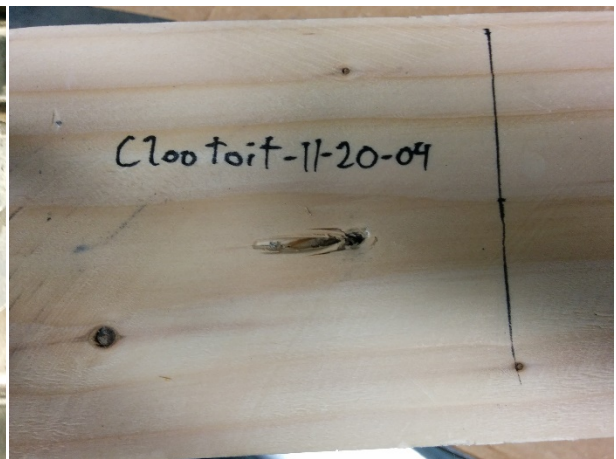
État de la section de bois à la rupture de l'assemblage Clou toit #11 1-1/2-20-4
